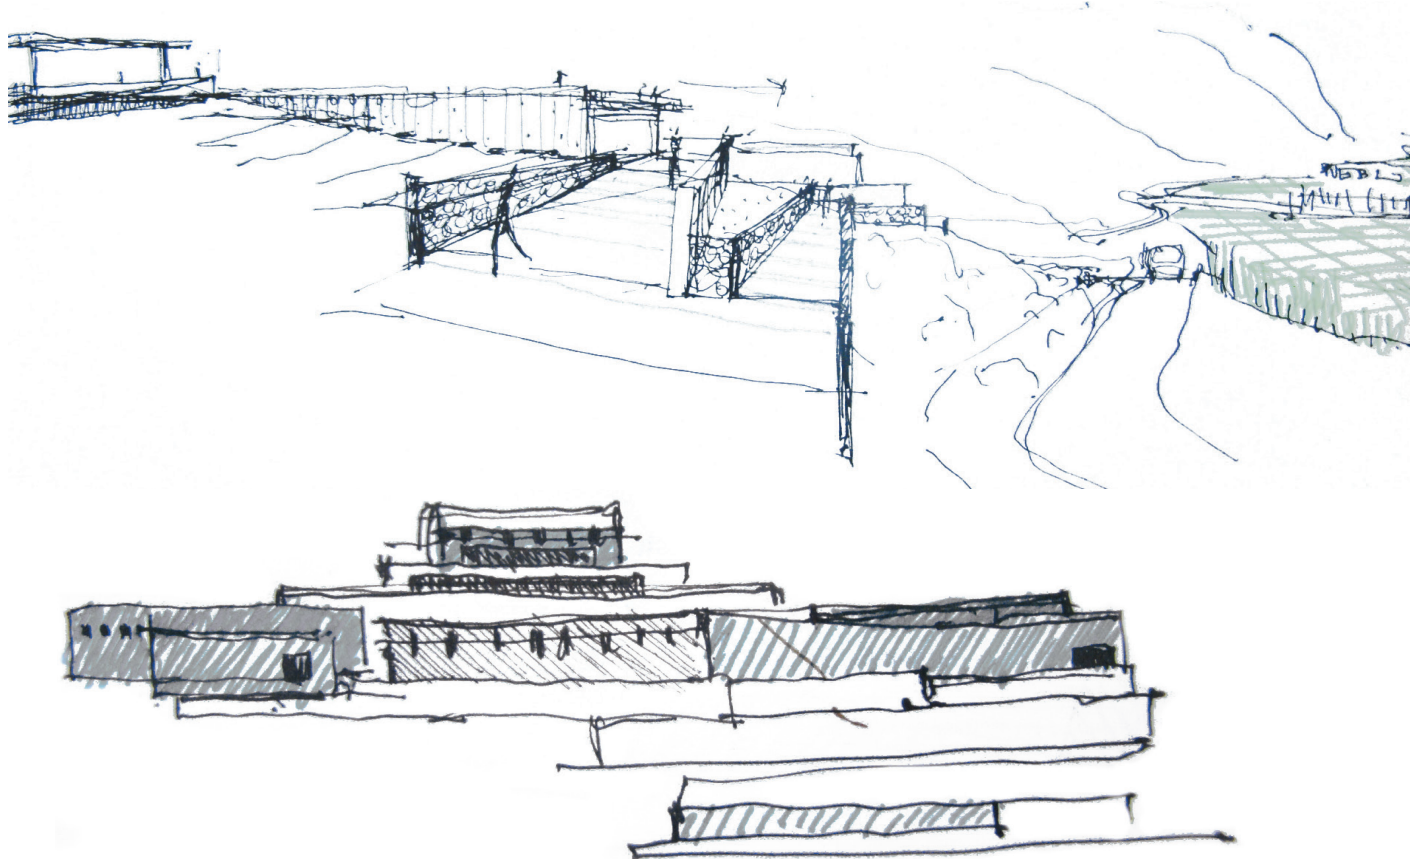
Elevación de proyecto. Volúmenes que sobresalen de un recorrido a través de muros de piedra.
